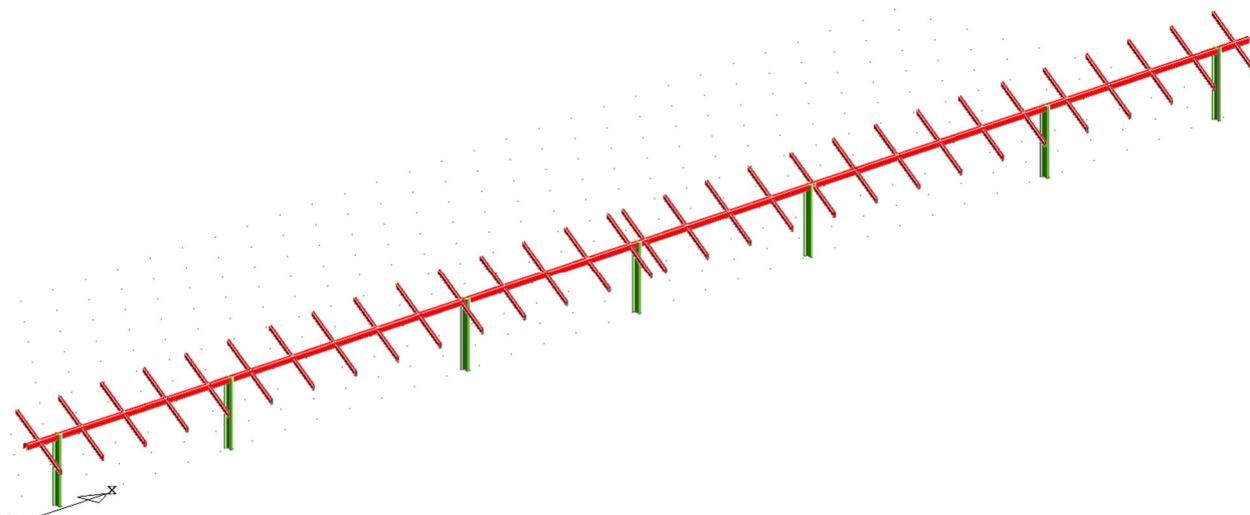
Vista assonometrica modello strutturale con posizione della “vela” inclinata di 60°
